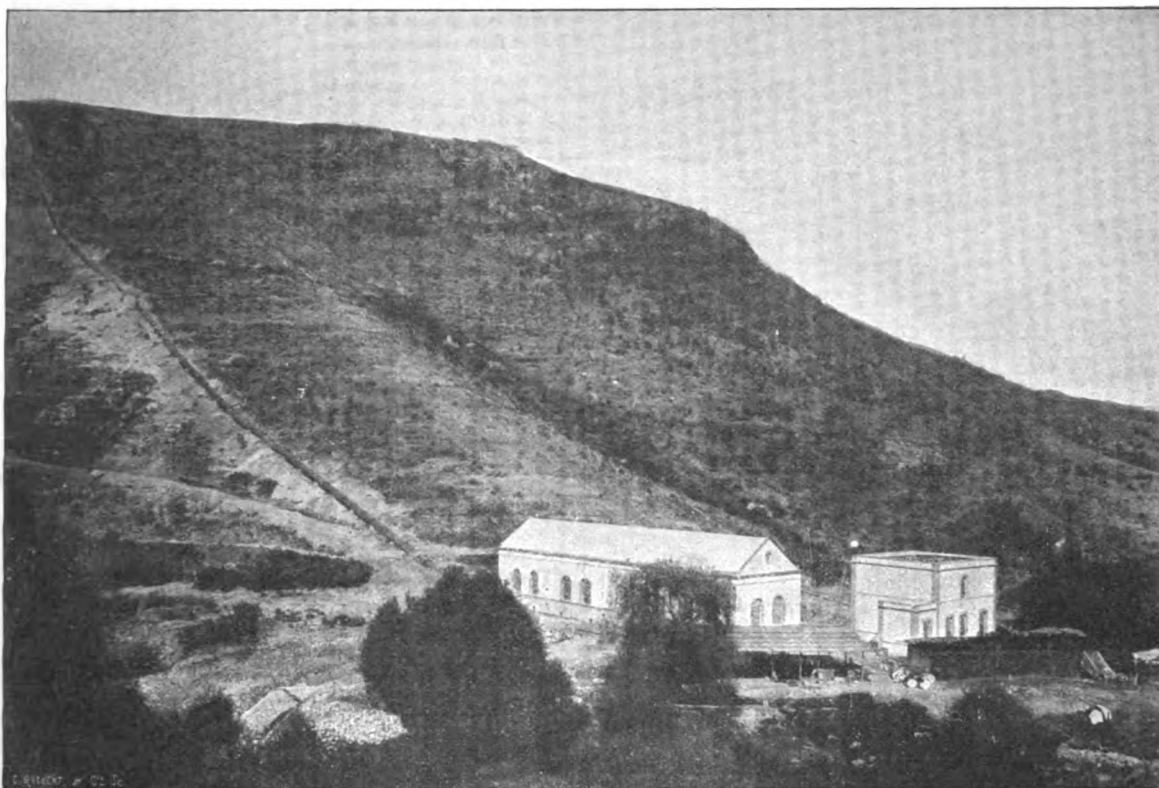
Conduite forcée amenant l'eau à la station de Villada.
